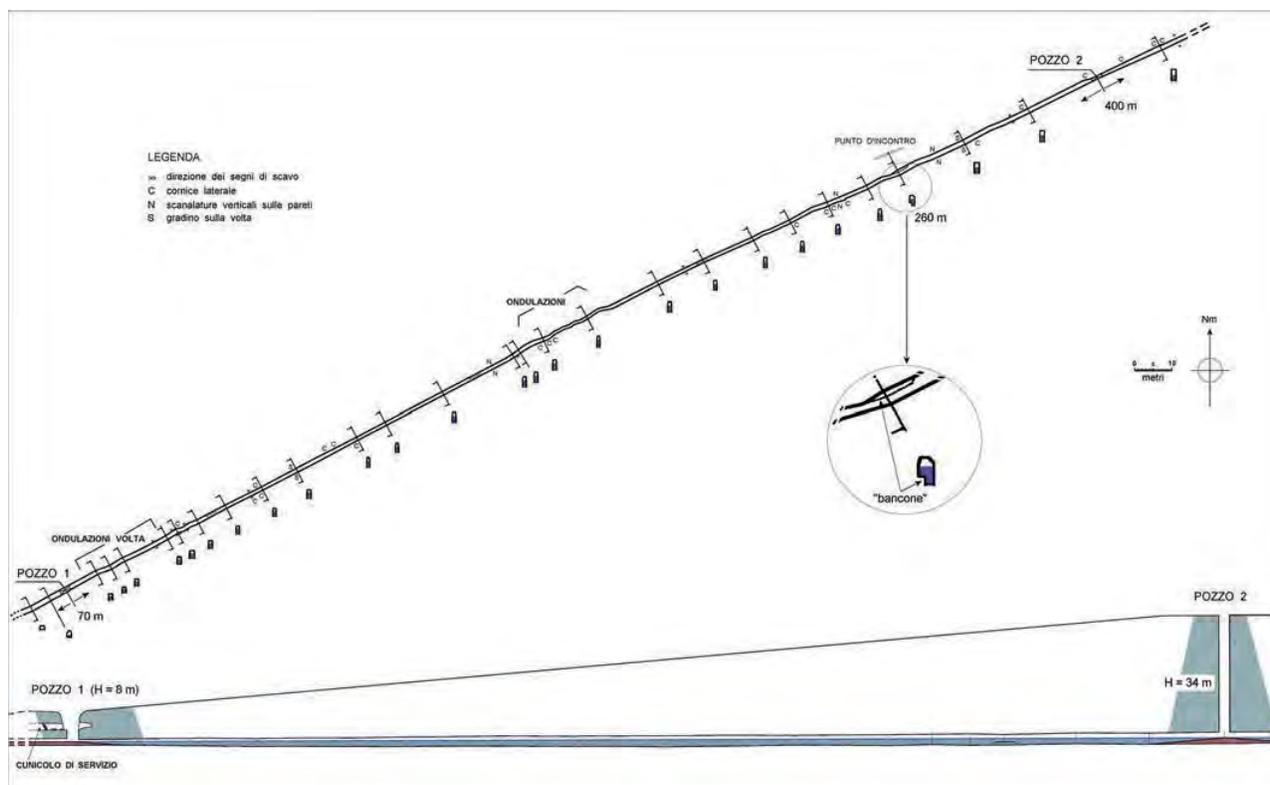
Emissario Albano: stralcio del rilievo planimetrico (con sezioni trasversali) e sezione longitudinale, dal pozzo 1 al pozzo 2 (disegno C. Germani con aggiunte di L. Casciotti).
